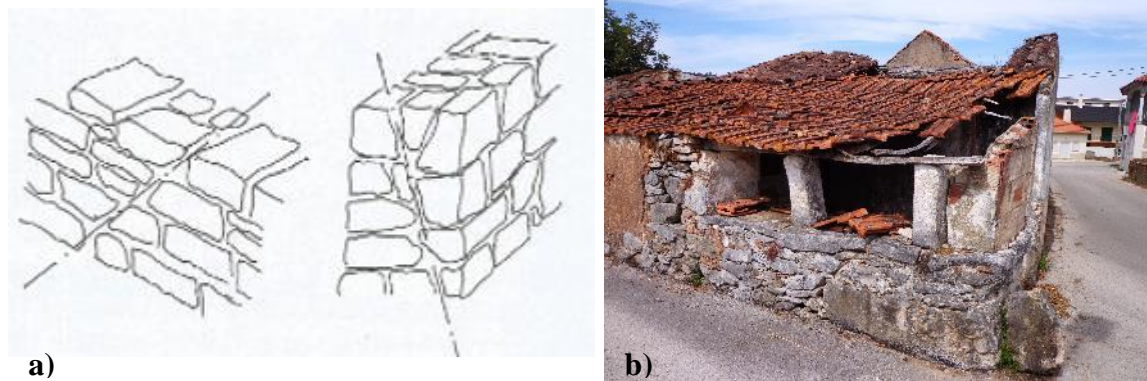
Alinhamento de juntas - alvenaria instável; b) Muro com junta alinhada que provoca deslizamento da alvenaria, instabilizando a estrutura da cobertura
